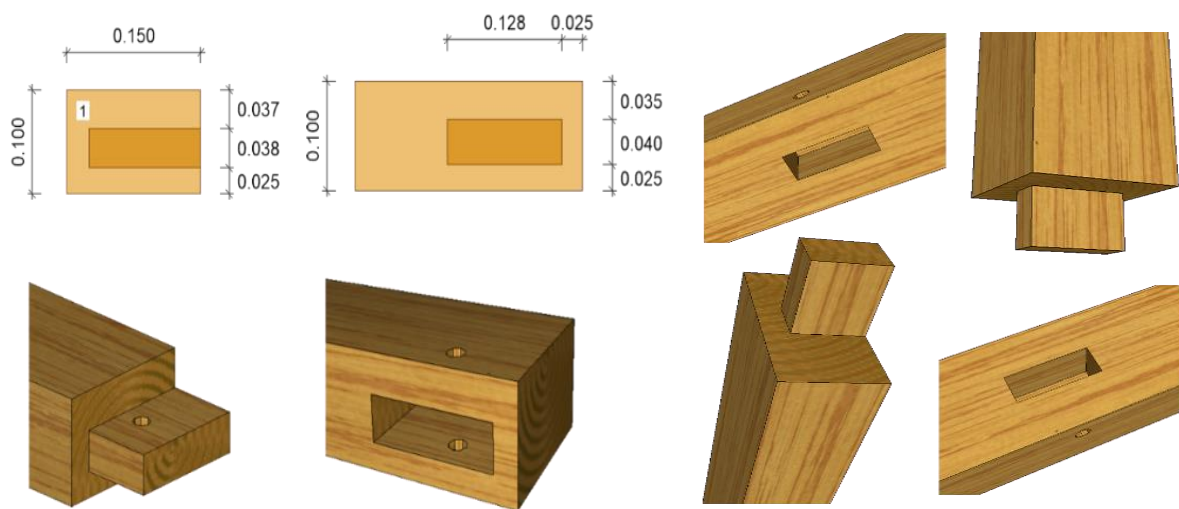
Варіант шипового з'єднання (шип-паз)
